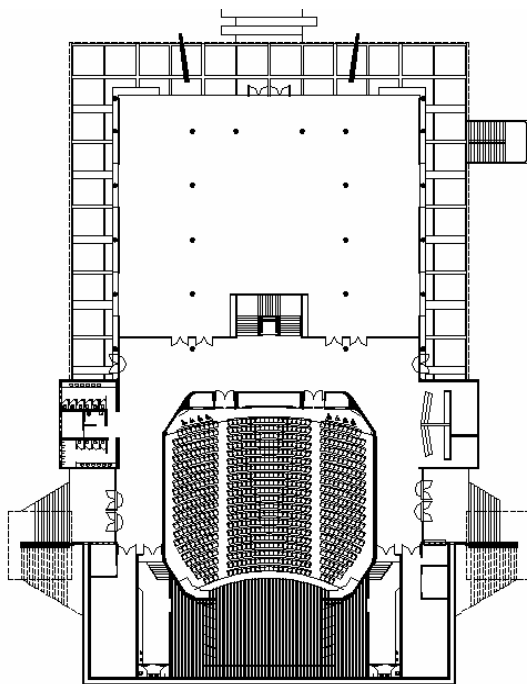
Planta pavimento semi-enterrado do edifício Pós-Graduação Unicnp (fonte: MCA, 2006).
